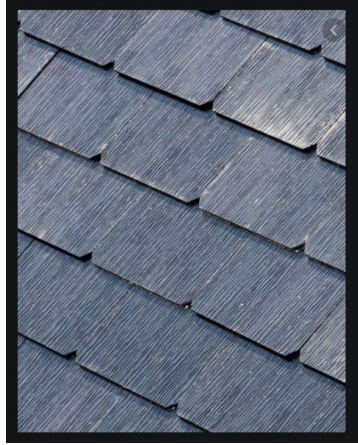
Telha ranhurada tipo Shingle e arranjo
